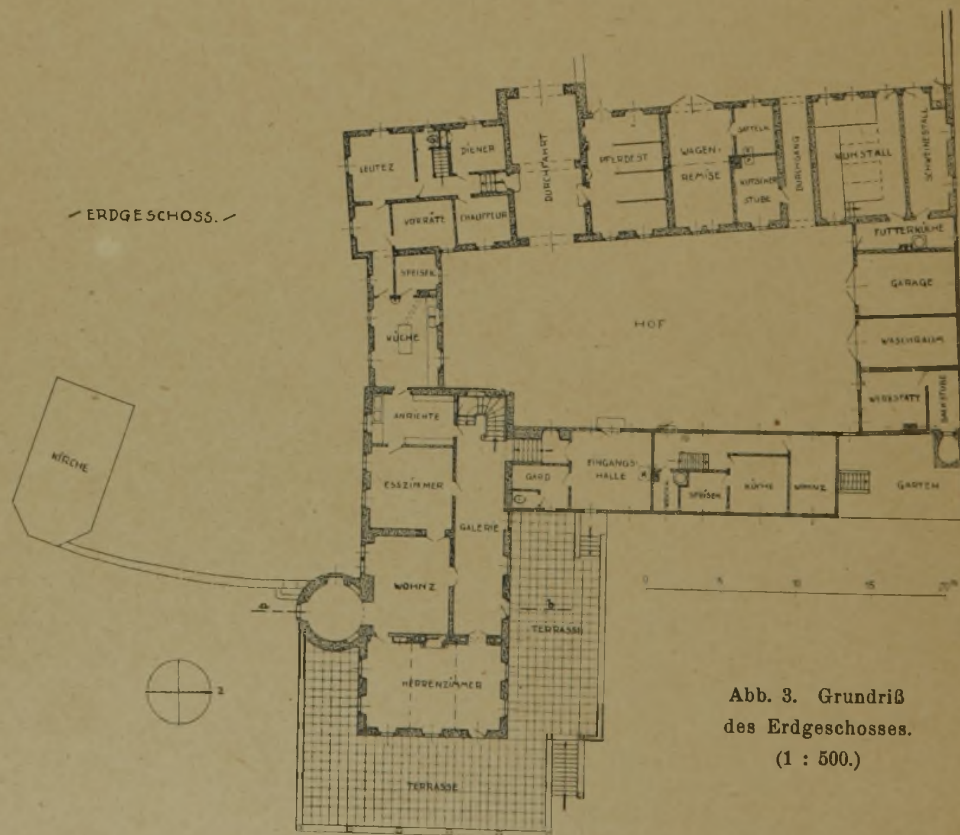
Grundriß des Erdgeschosses. (1 : 500.)
